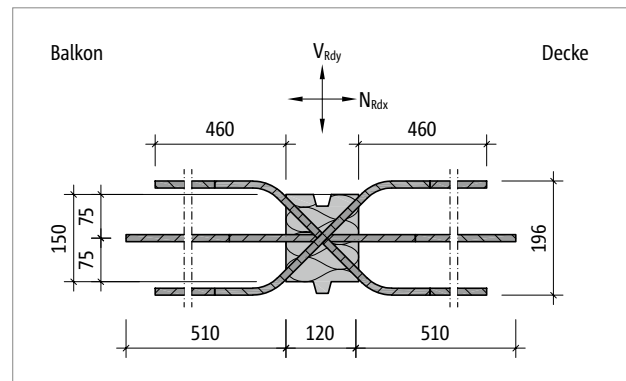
Schöck Isokorb® XT Typ HP-VV2-NN1: Produktgrundriss
